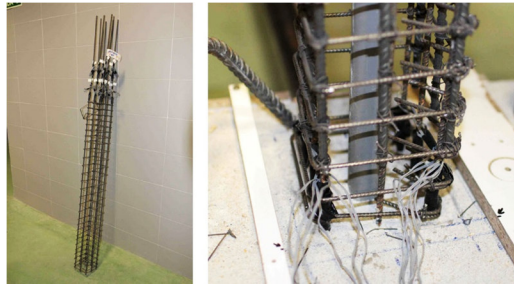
Preparación de la armadura de los pilares para su hormigonado.
